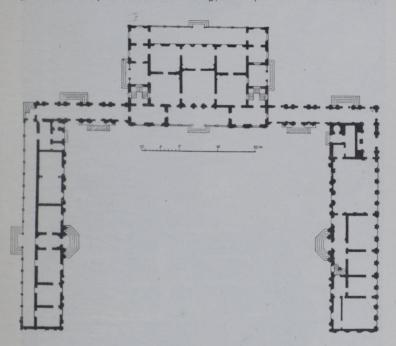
Schloß Willanow bei Warfchau. Grundrif des Erdgeschoffes.
